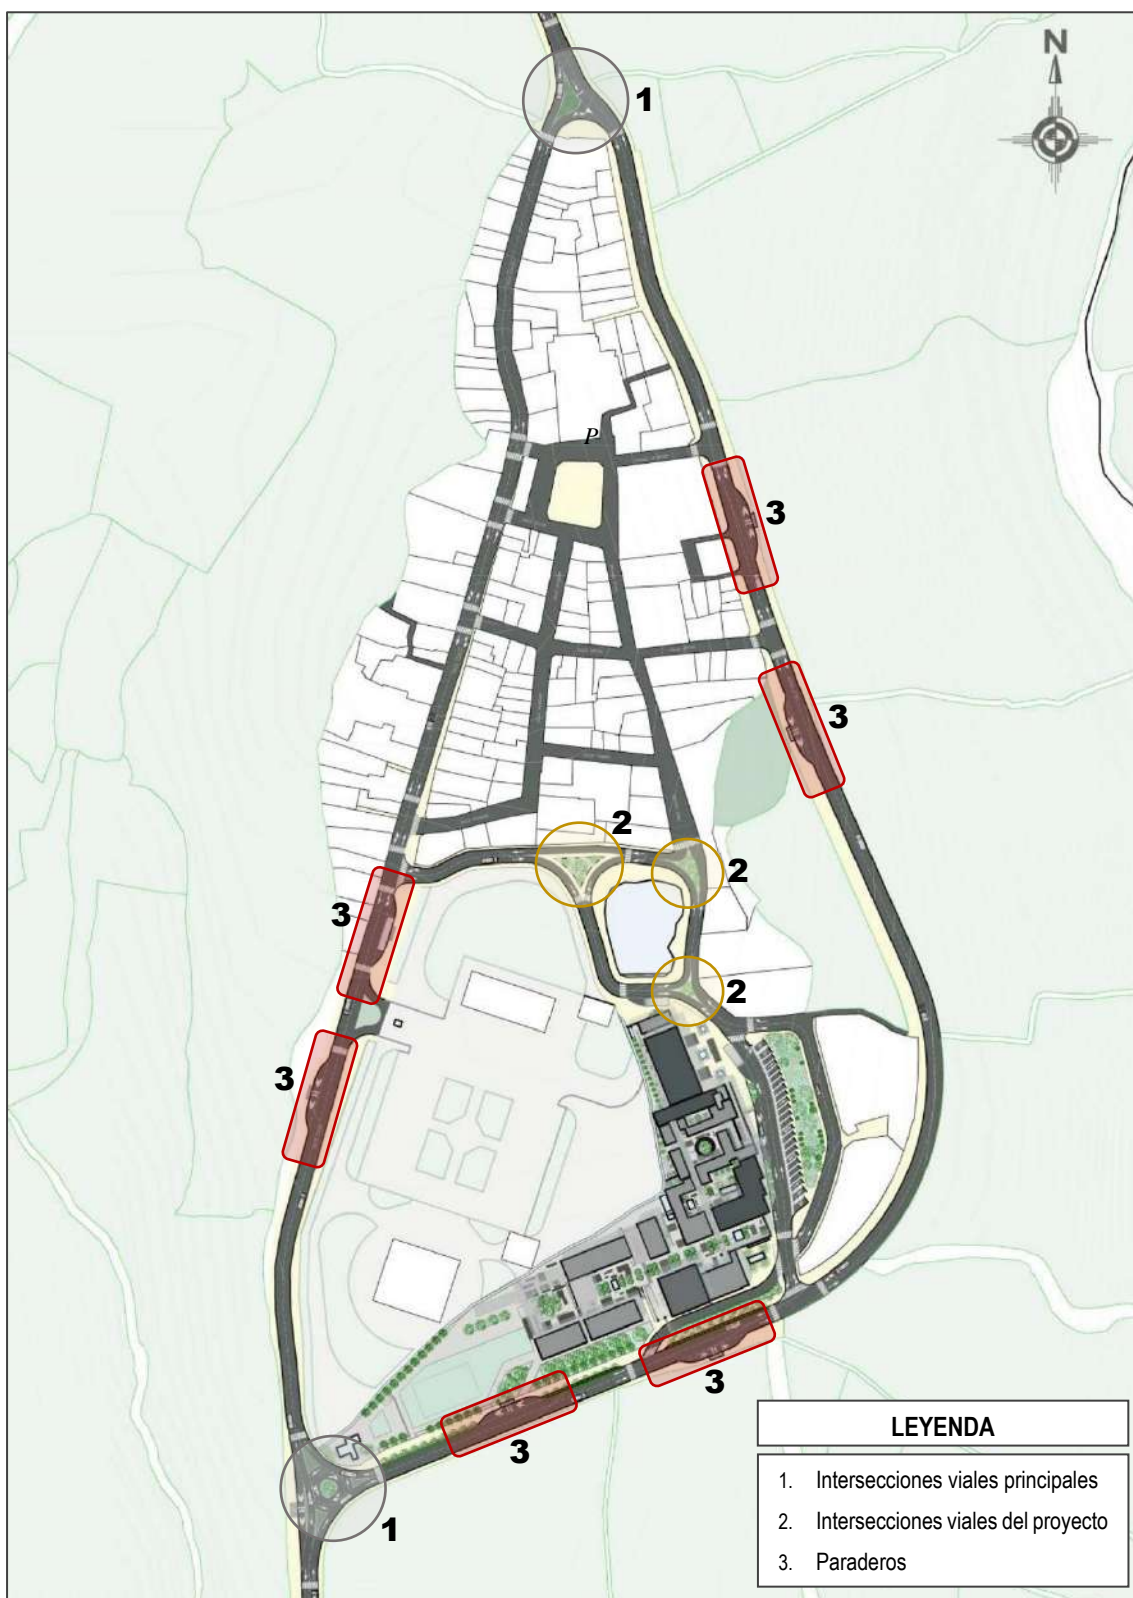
Master plan - Propuesta urbana. Fuente: Elaboración propia.
